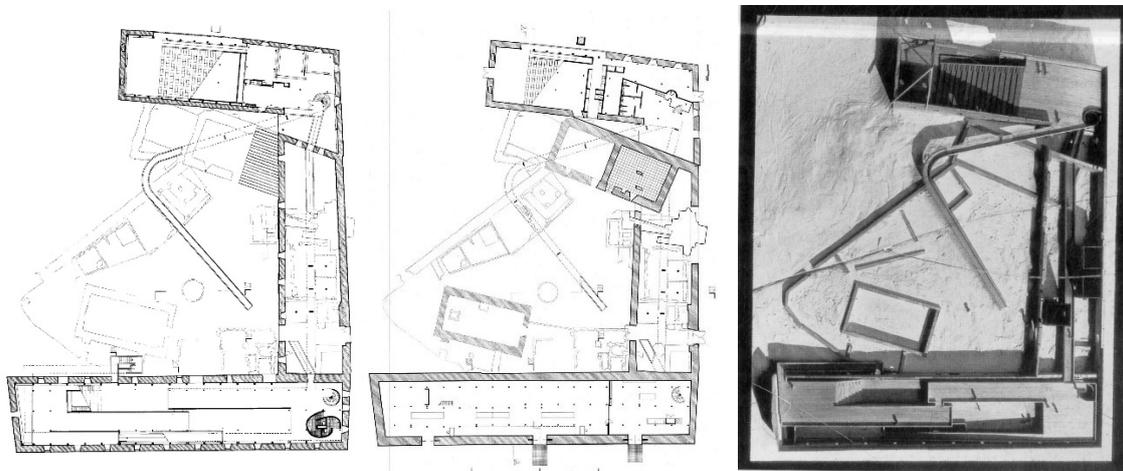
, b, c. Sverre Fehn. Museo Episcopal de la Catedral Hedmark (Hamar, 1967-79). Planos de planta y foto de maqueta
